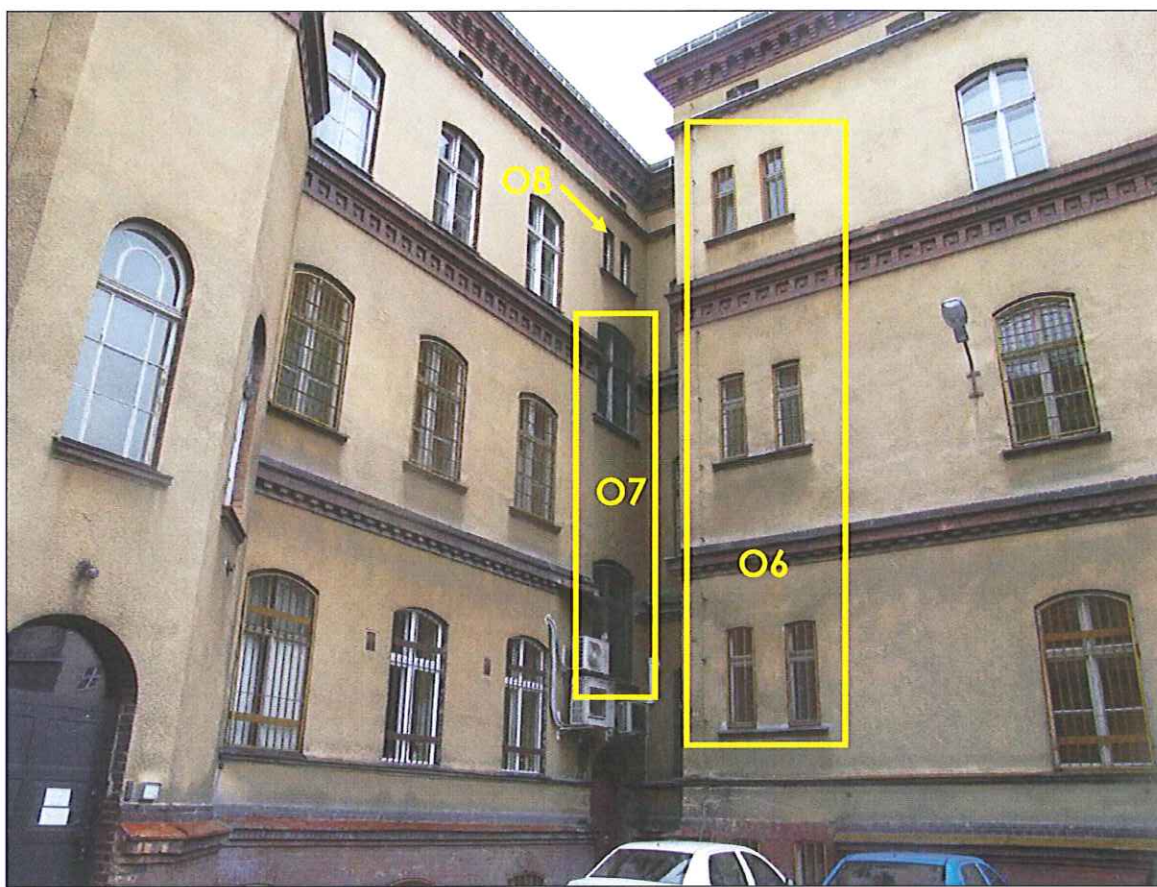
Elewacja południowa – przykładowa lokalizacja typów okien
